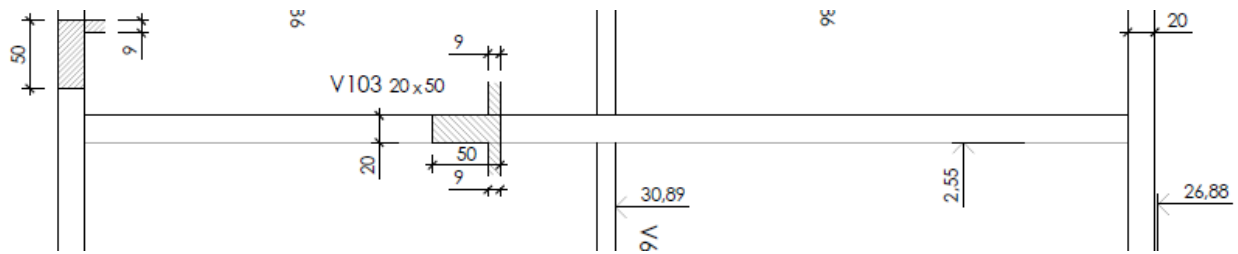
Esquema estructural viga 62 (Fuente: Elaboración propia)
